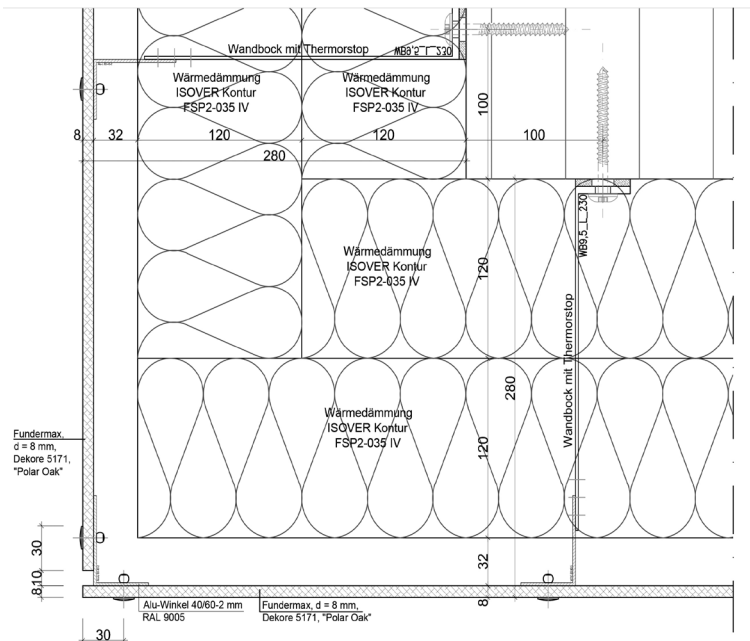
Detailzeichnung einer Außenecke der Vorhangfassade (© Trauco-Spezialbau GmbH)
